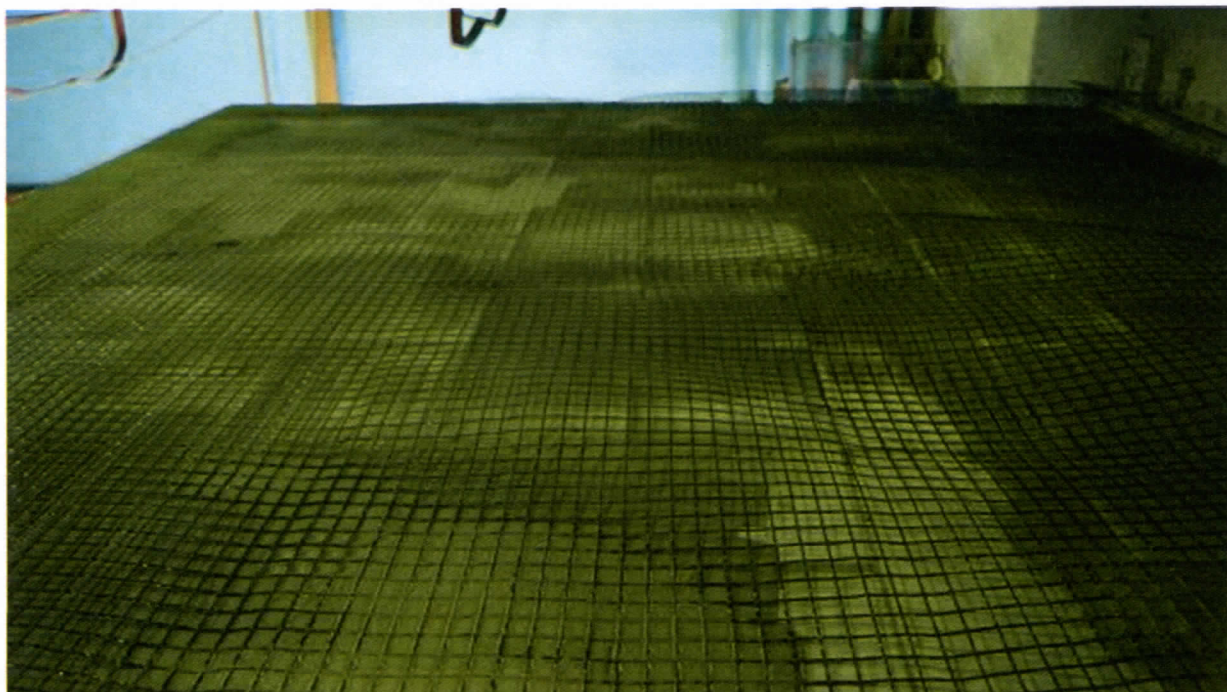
Раскладка вертикальной арматуры
